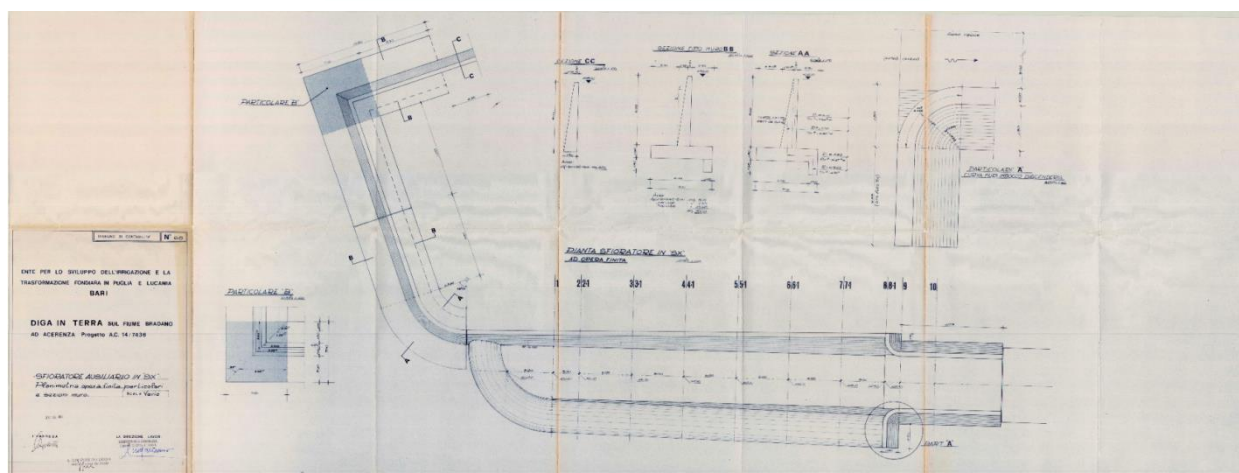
Estratto Tav. 65 – Planimetria opera finita
